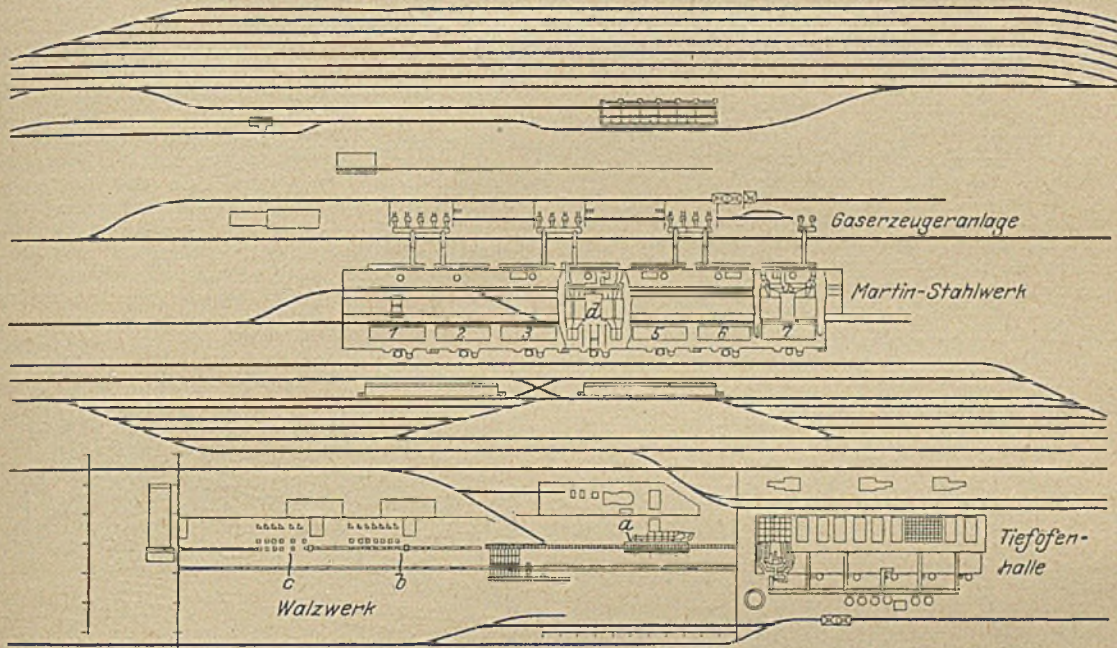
Lageplan der Neuanlage der Trumbull Steel Co. in Warren.
